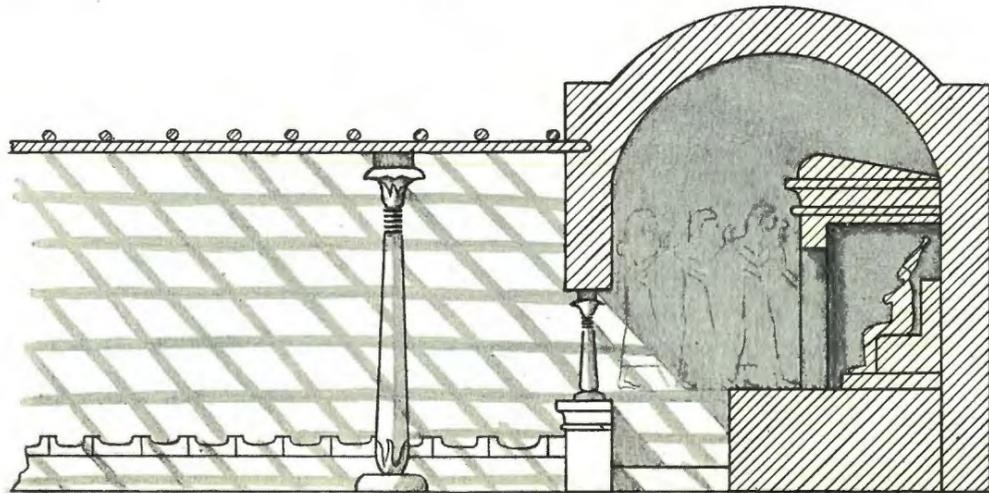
COUPE LONGITUDINALE DE LA CHAPELLE.
